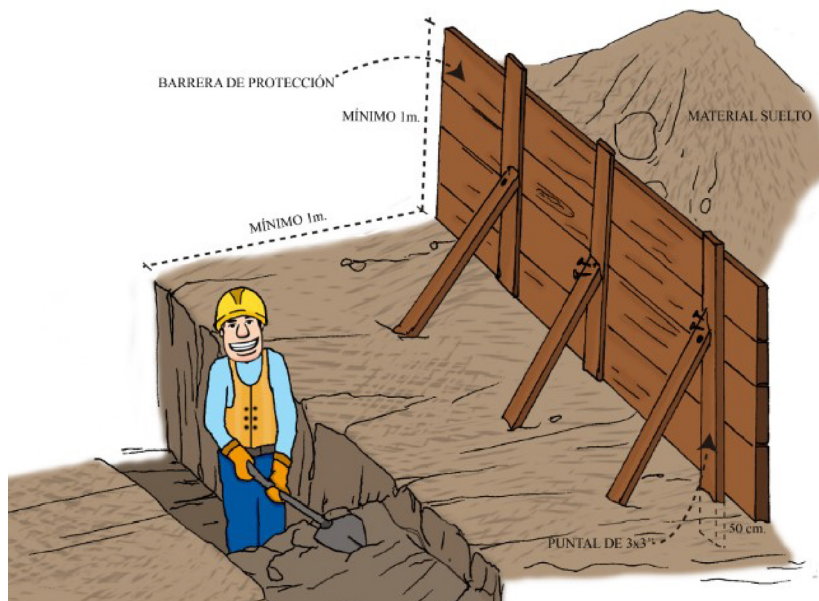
Barrera protectora para excavación de zanja de muro de contención
